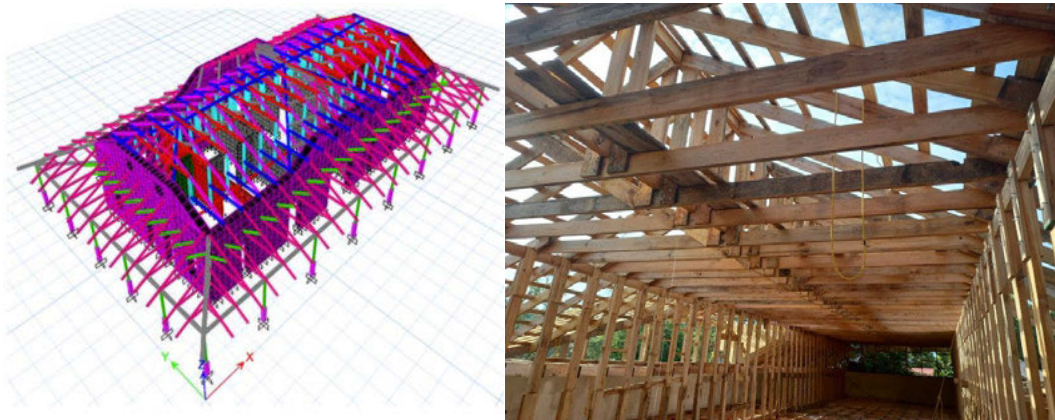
Reconstrucción de la estructura de cubierta. Dictamen estructural del proyecto (2019)
